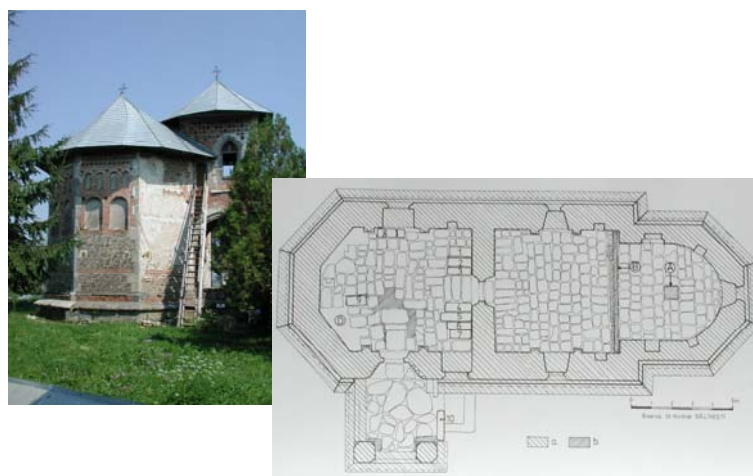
Igreja de São Nicolau (Bălinești) – visão geral e planta construtiva
